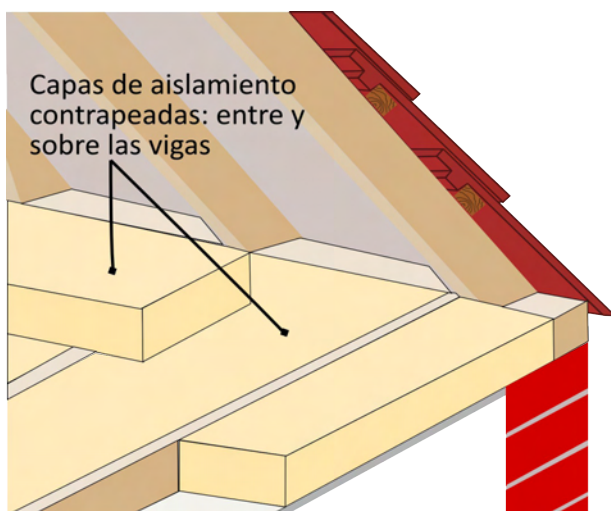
Buena práctica para el aislamiento de bajo cubiertas no habitables. Estructuras ligeras de madera o metálicas.
